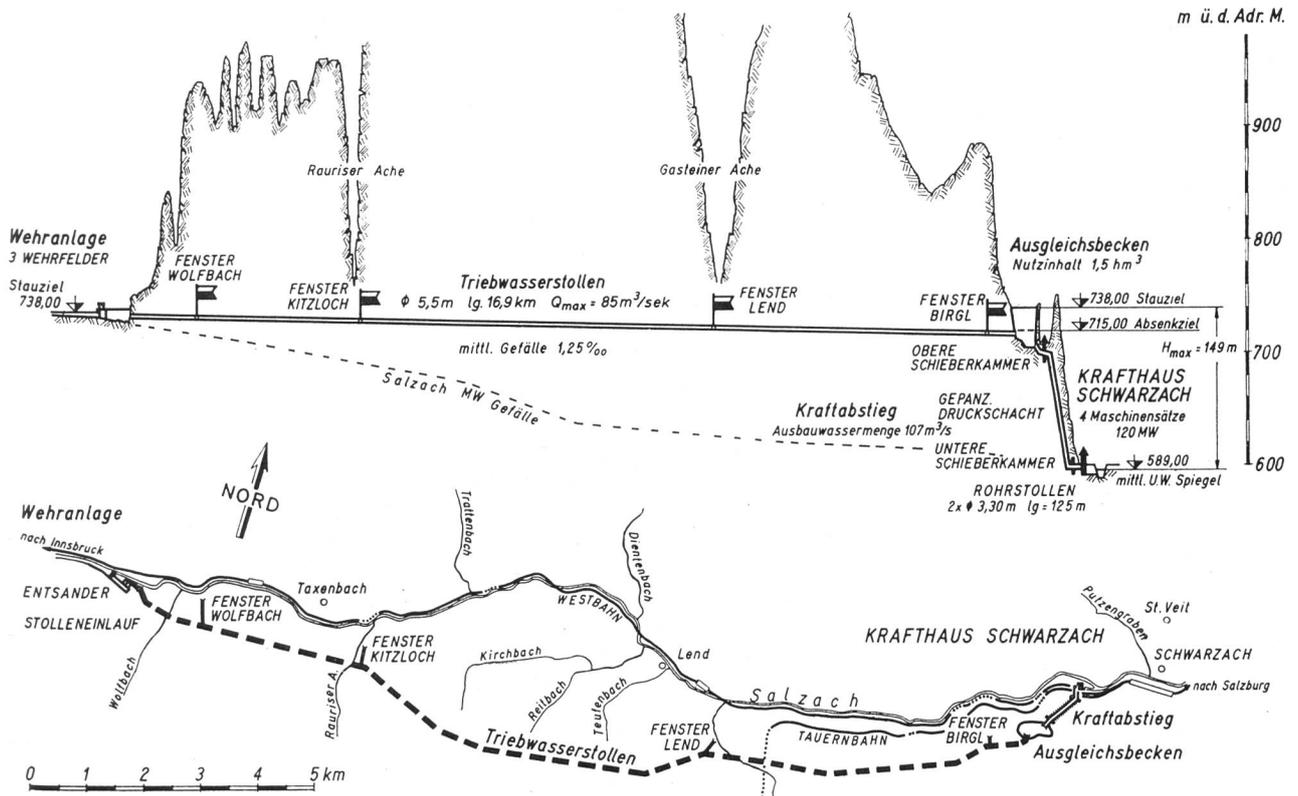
Längenprofil und Lageplan des Kraftwerkes Schwarzach
